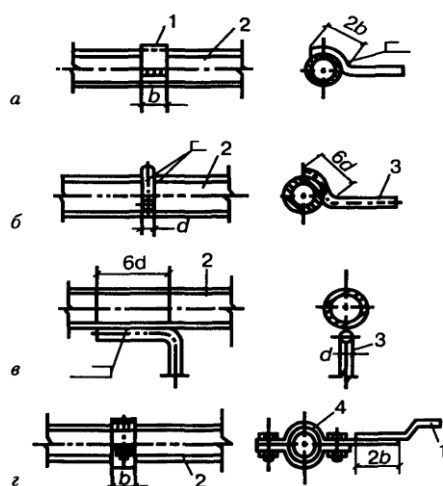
Присоединение заземляющего проводника к трубопроводу сваркой (а - в) и с помощью хомута (г); 1 - заземляющий проводник из полосовой стали; 2 - трубопровод; 3 - заземляющий проводник из круглой стали; 4 – хомут
